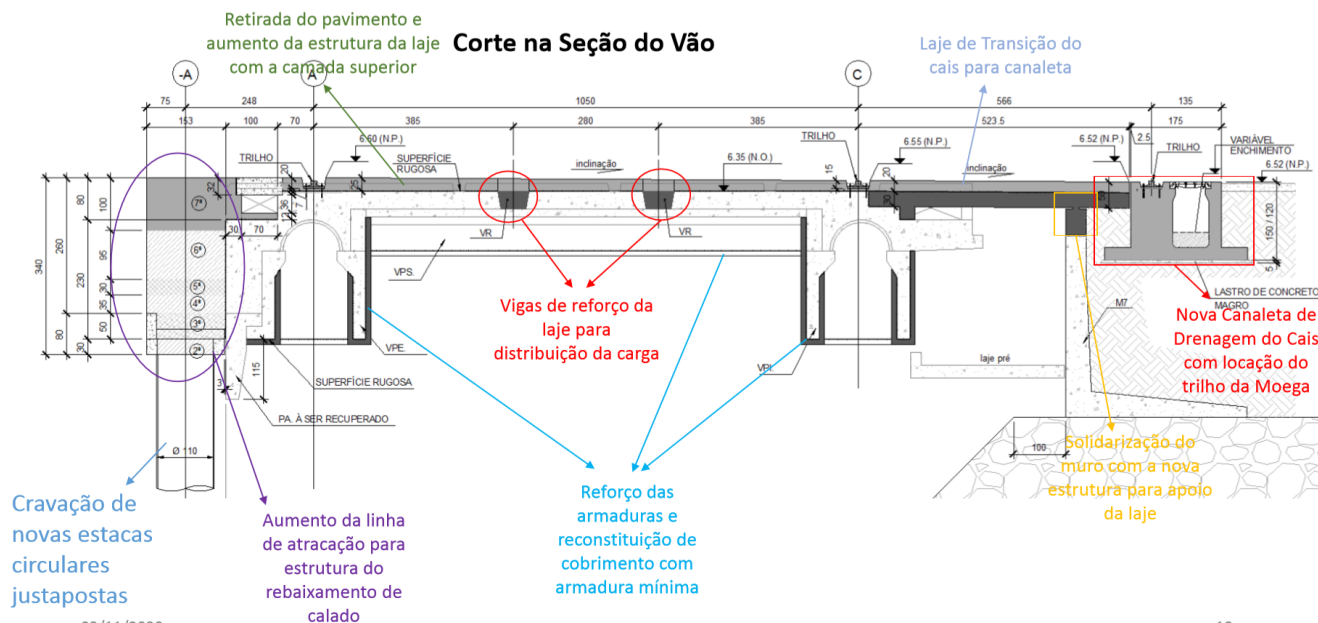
Croqui de reforço e recuperação do Cais – Seção transversal
